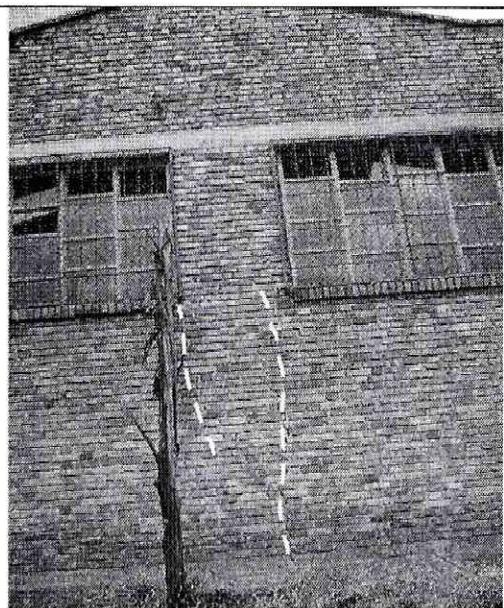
Se observa la grieta que inicia de la viga de amarre y continua por el muro
